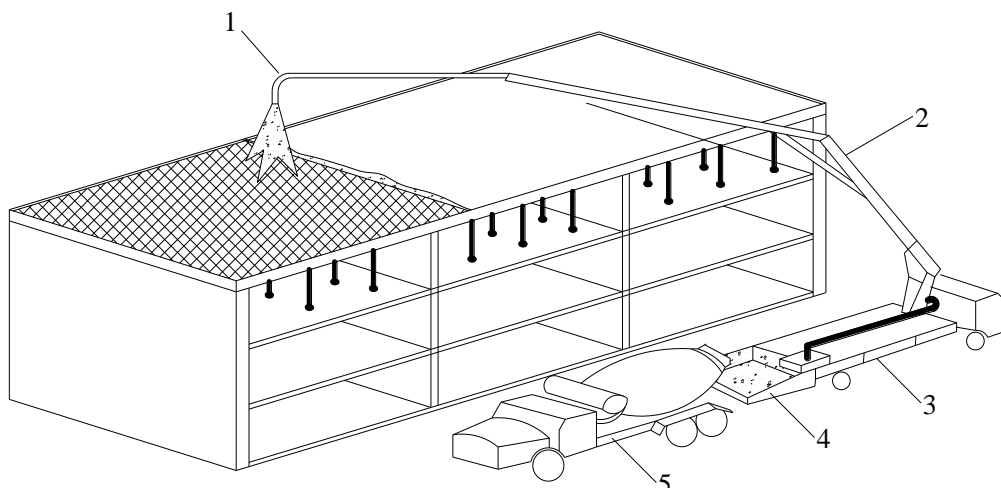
Схема бетонування за допомогою автобетононасосу з розподільчою стрілкою:
